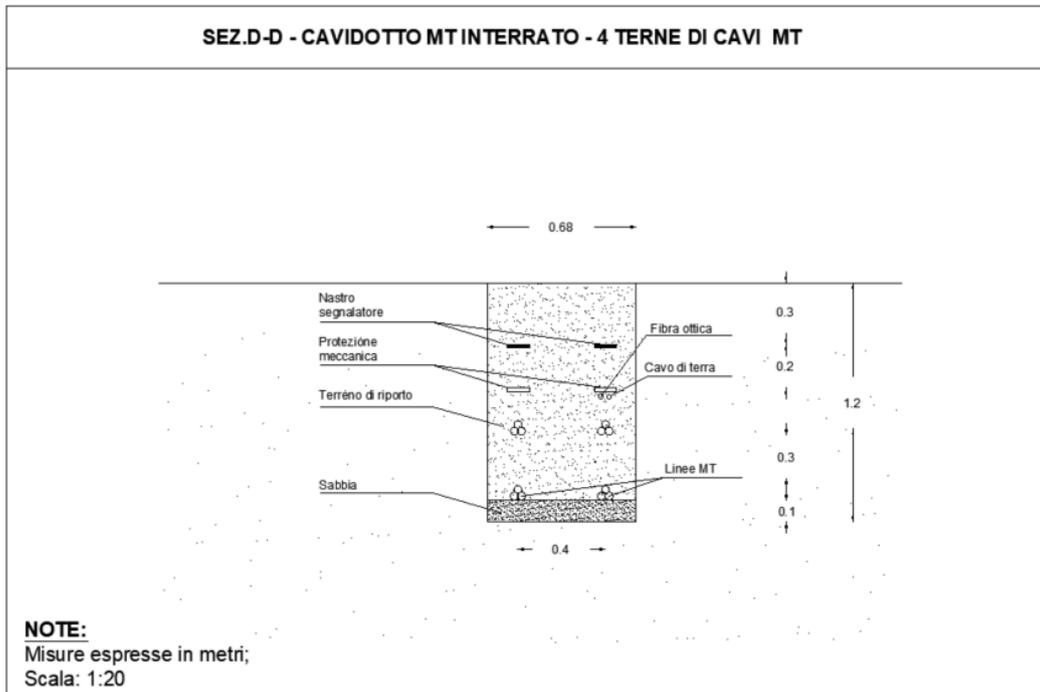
Stralcio elaborato "CEN.ENG.TAV.028._Planimetria dei cavidotti con indicazione delle sezioni di posa" – Sezioni per interrimento del cavidotto MT
